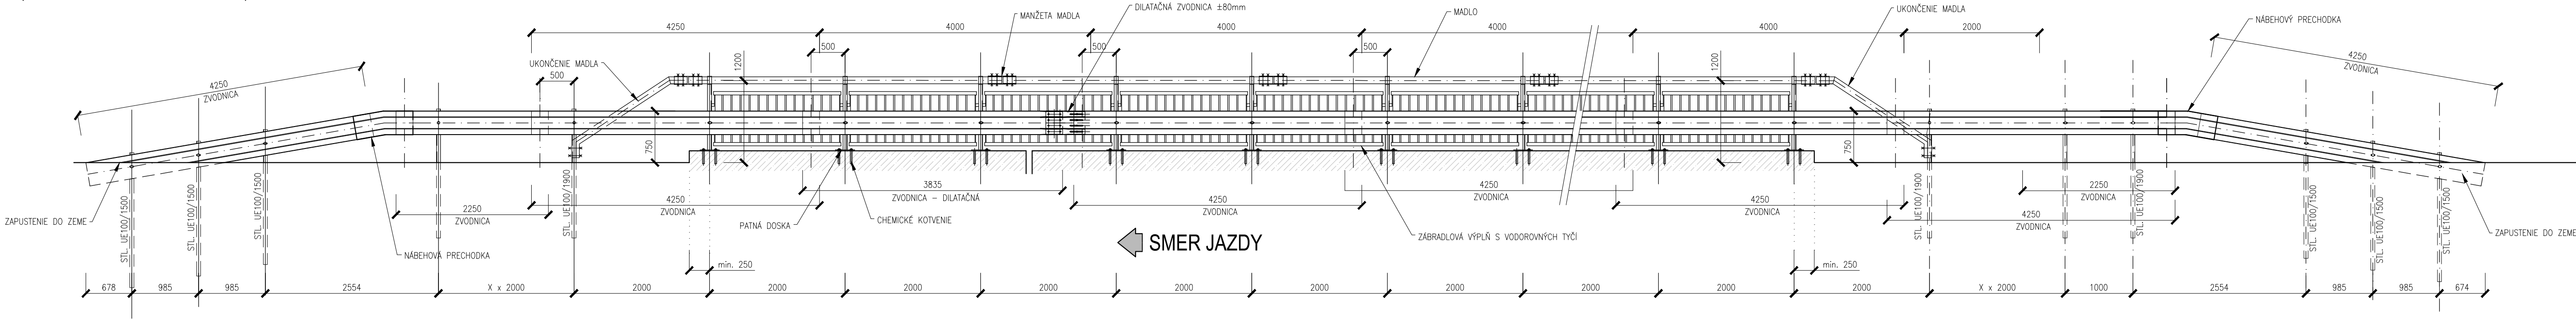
DETAIL VÝPLNE ZÁBRADLIA - ROZMIESTNENIE M 1:5
